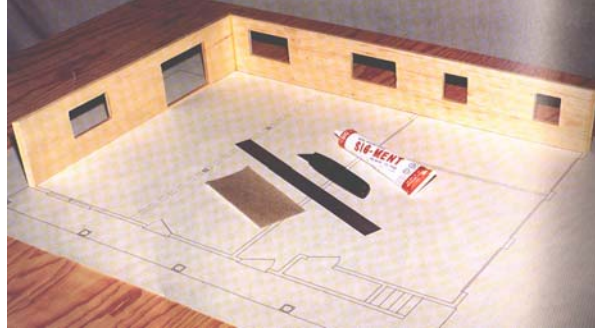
مسقط أفقي للدور الأول.
